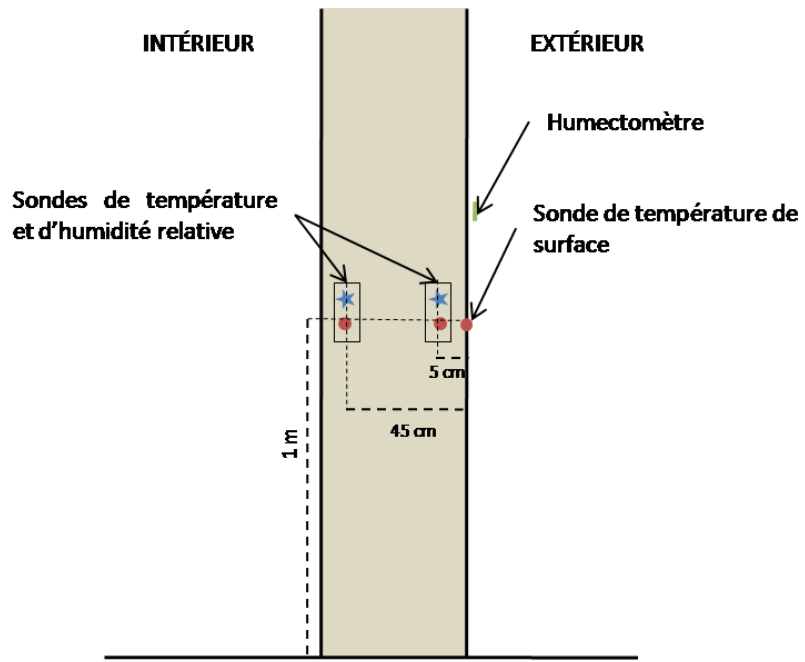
Plan de l'instrumentation de la paroi Sud au droit de la cuisine
